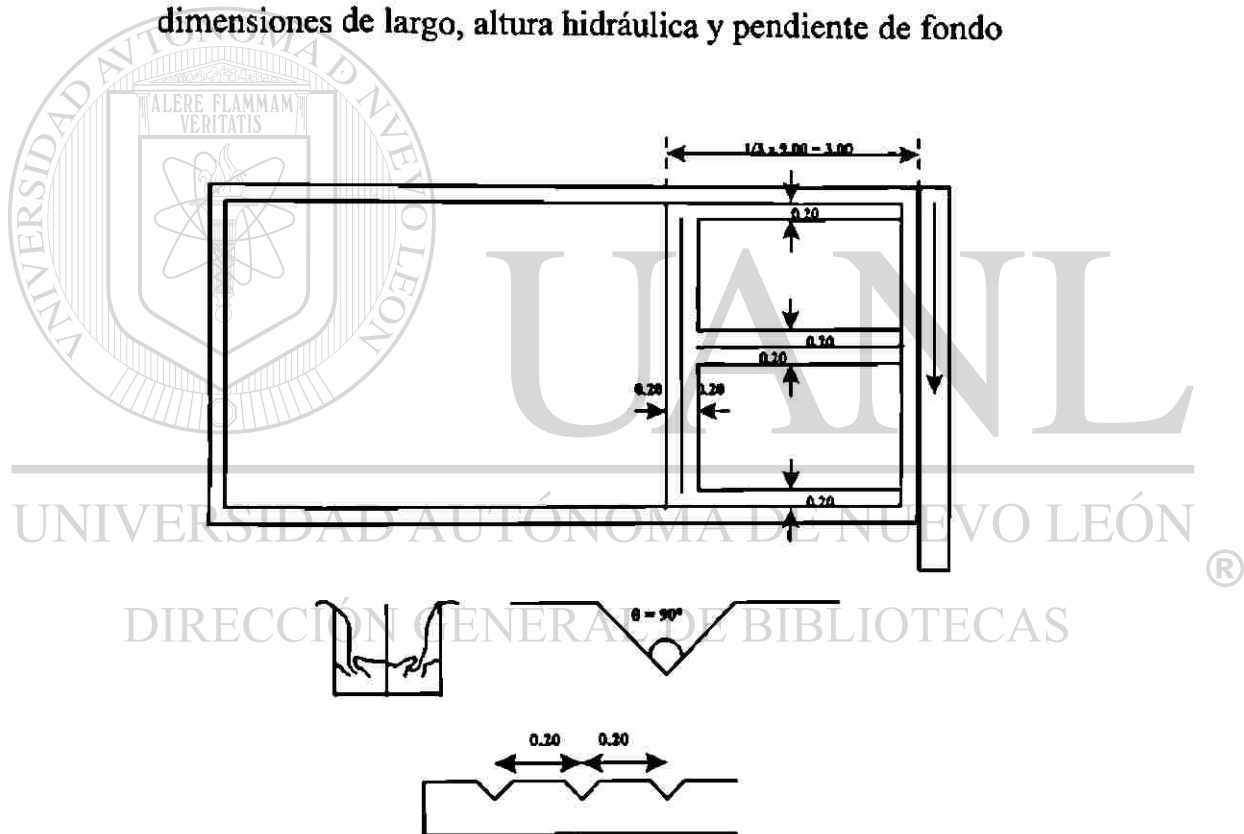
Planta de canaleta y tipo de vertedores.
